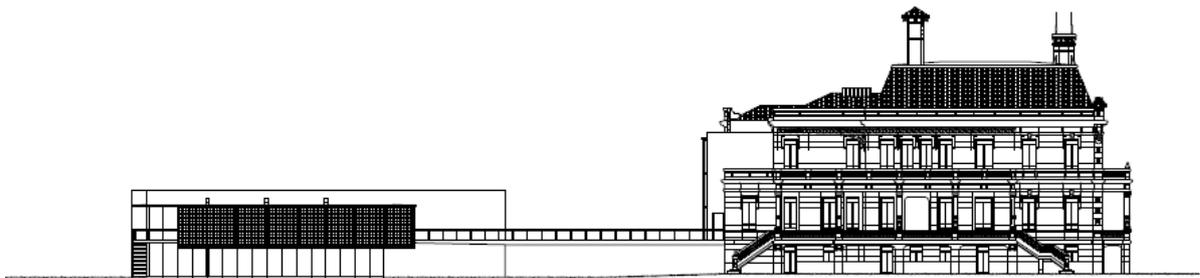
Vista externa do pavilhão e jardim de esculturas do *Palacete das Artes* (BRASIL ARQUITETURA, 2015)
